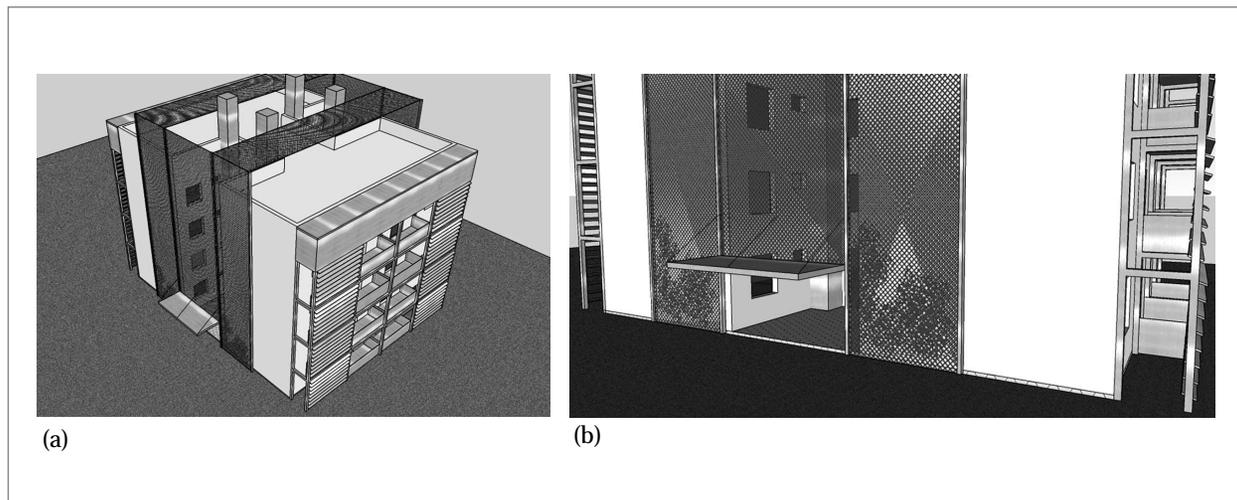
Propuestas de fachadas – Opción B – (a) balcones con posición fija y brises móviles y (b) detalle de la entrada del predio (estructura y tela metálica como apoyo para la fachada verde)
